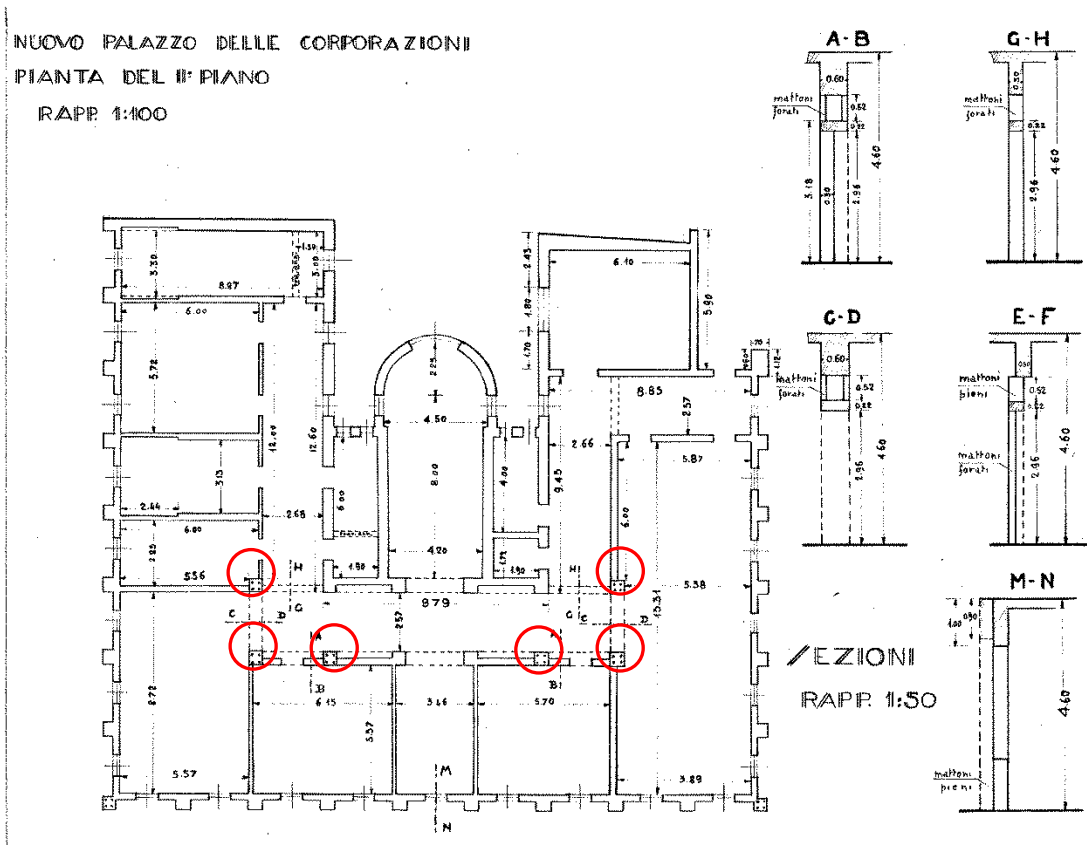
Pianta architettonica del piano 3° (da progetto esecutivo del 1937), con indicazione dei pilastri in c.a.
